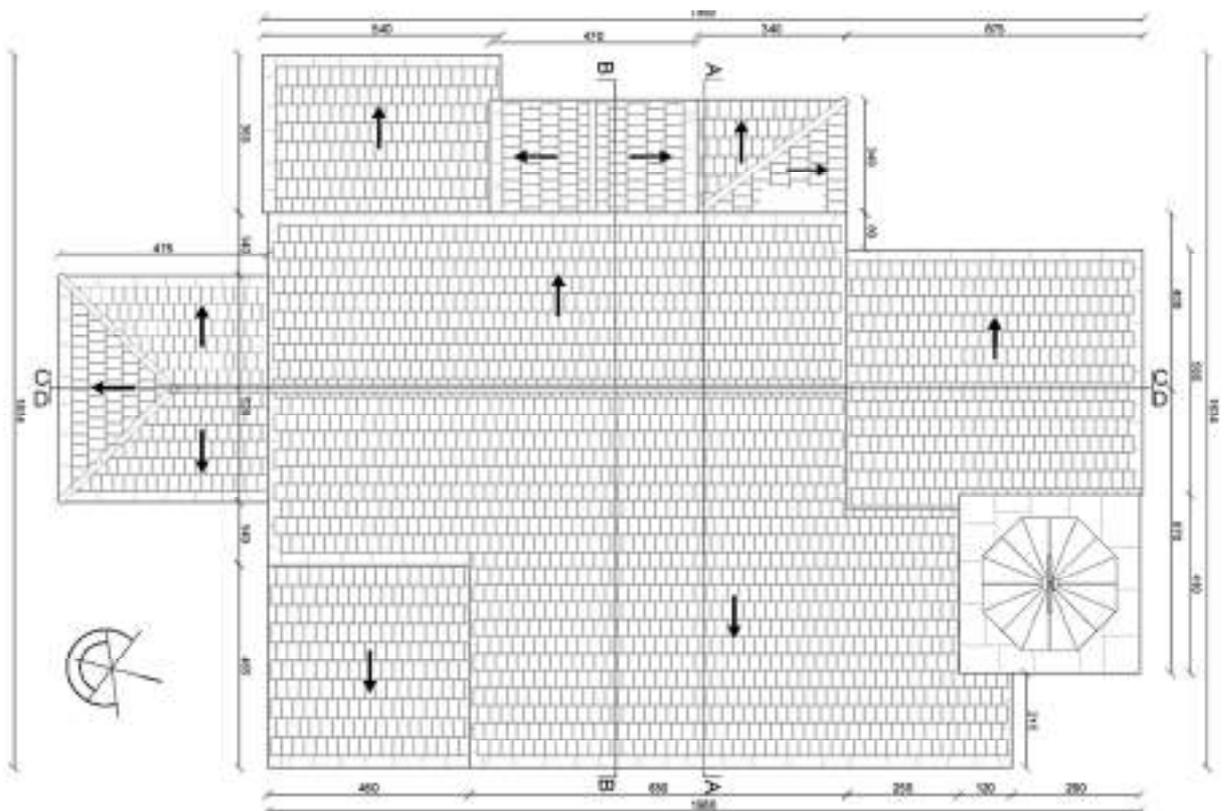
Pianta coperture (Fonte: Tavola 3B)
